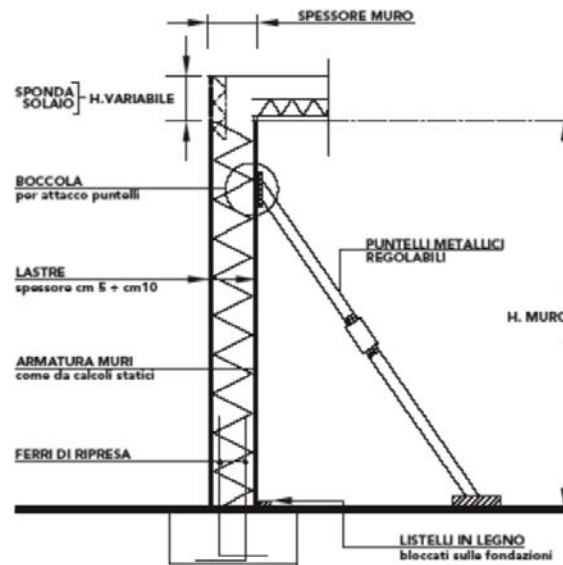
Sezione doppia lastra predalles in calcestruzzo
